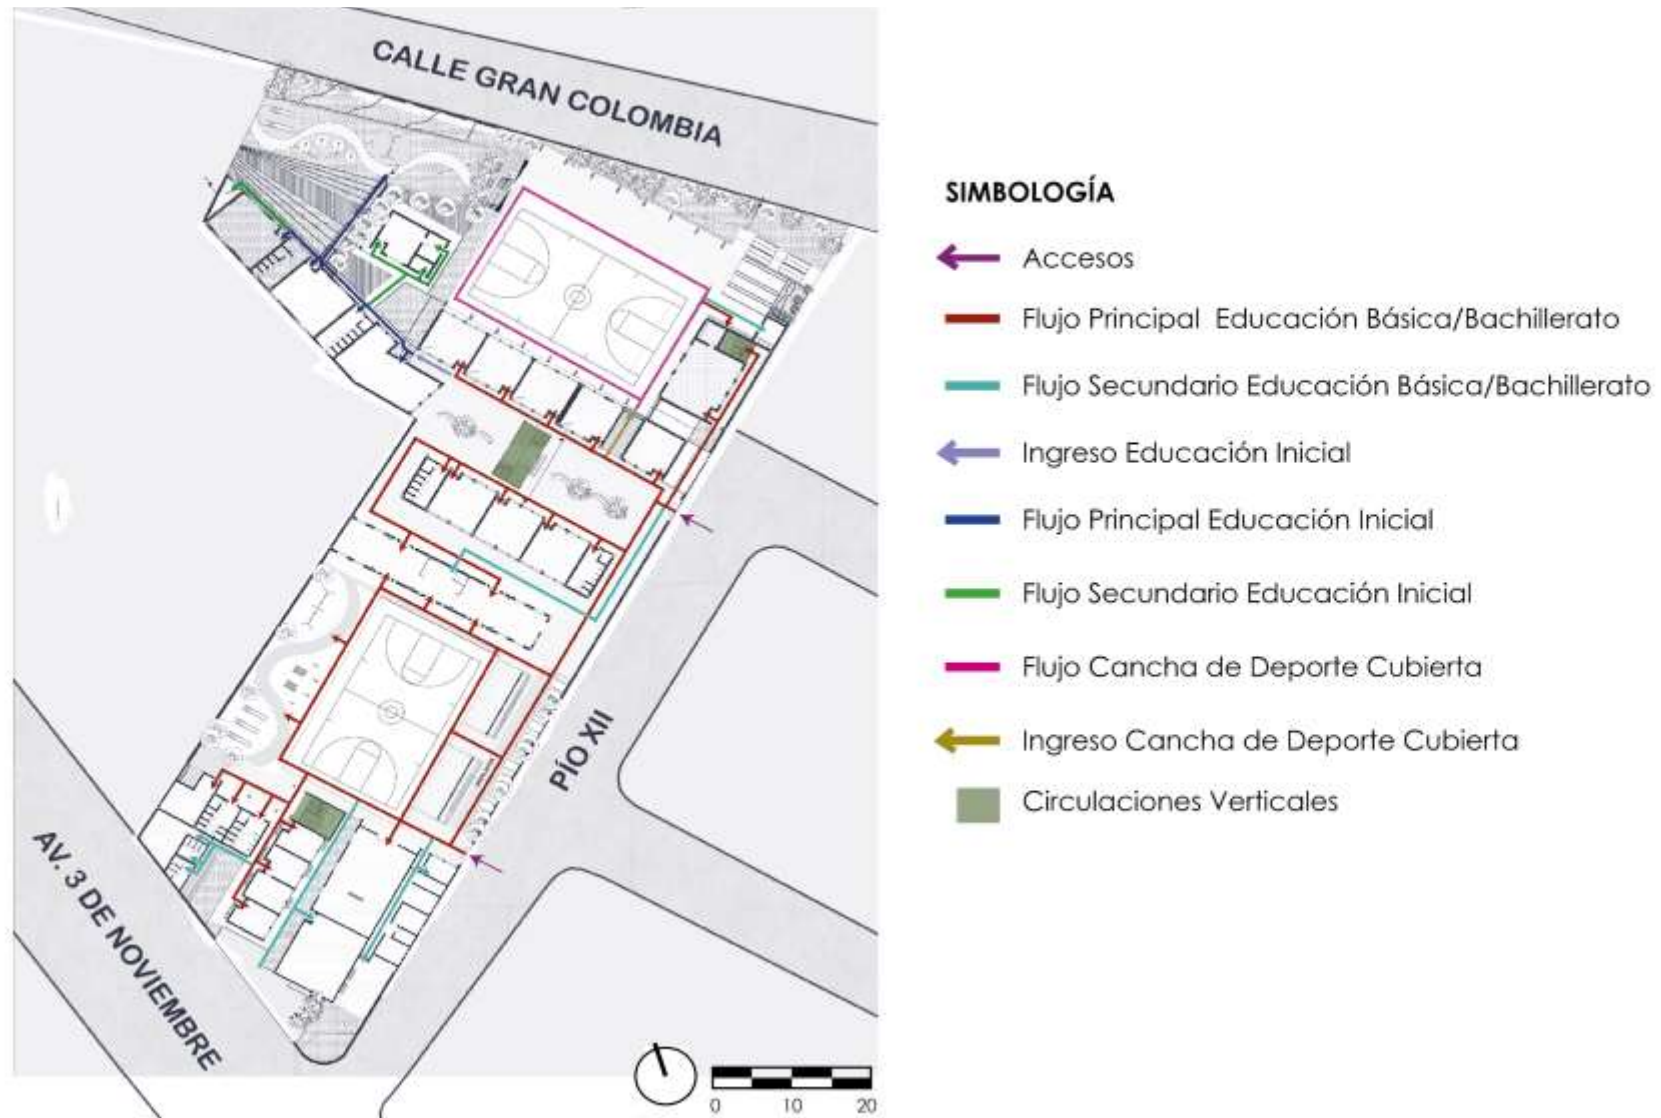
Organigrama de Correlaciones Propuesta de Readecuación Planta Baja
